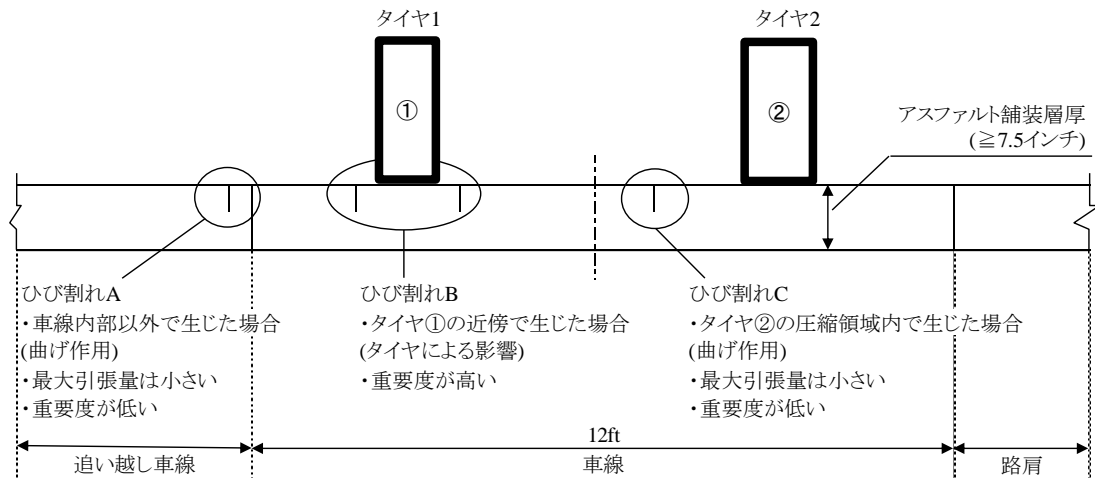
表面ひび割れの発生位置とその原因の概要
